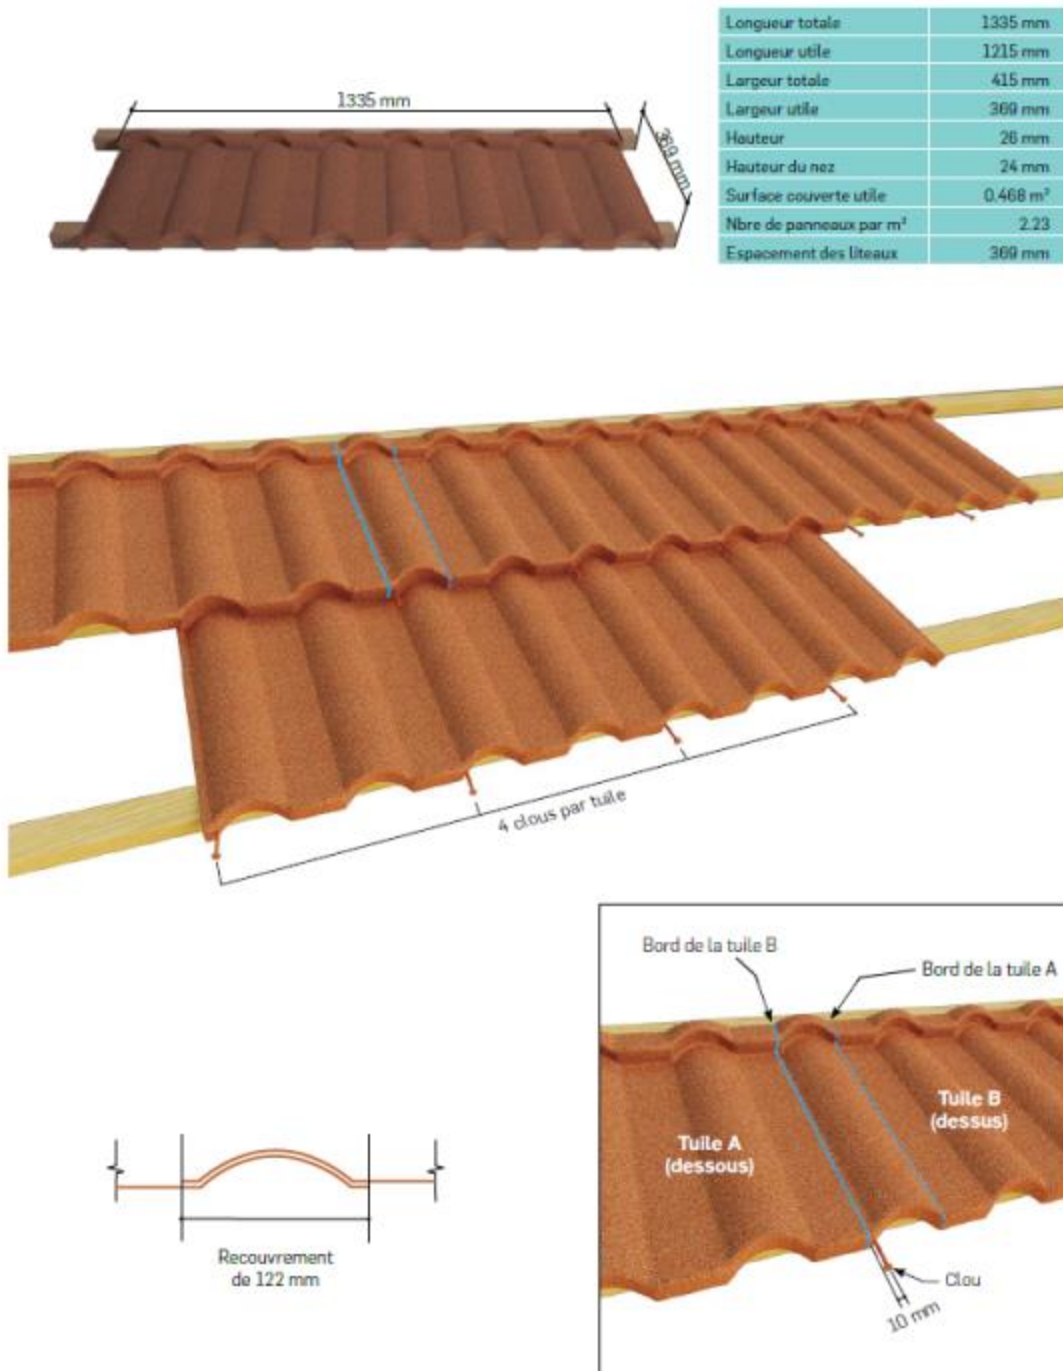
Tuile « GERARD MILANO », dimensions, clouage et recouvrement
